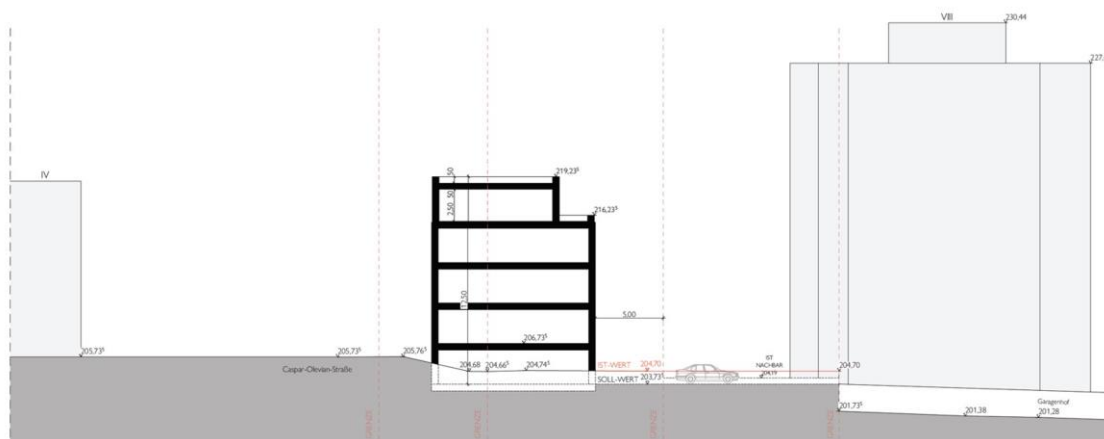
Gebäudeschnitt mit südlicher und nördlicher Nachbarbebauung (Pasucha Klepzig Architekten)
